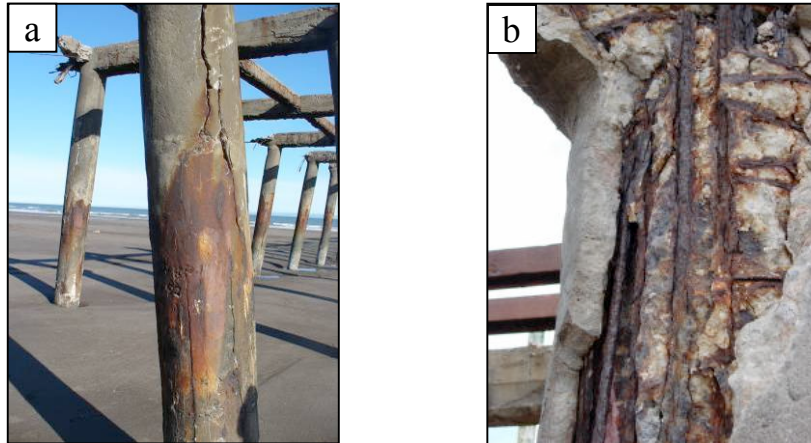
a: Organismos adheridos en pilotes del espigón Oeste, b: Zona de salpicaduras en espigón Este.
